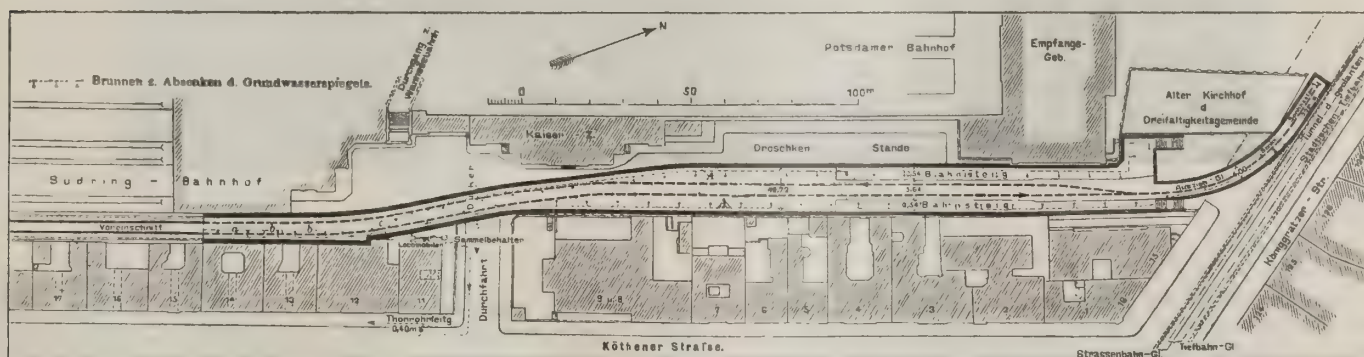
Baustelle der Untergrundbahn am Potsdamer Bahnhof.
